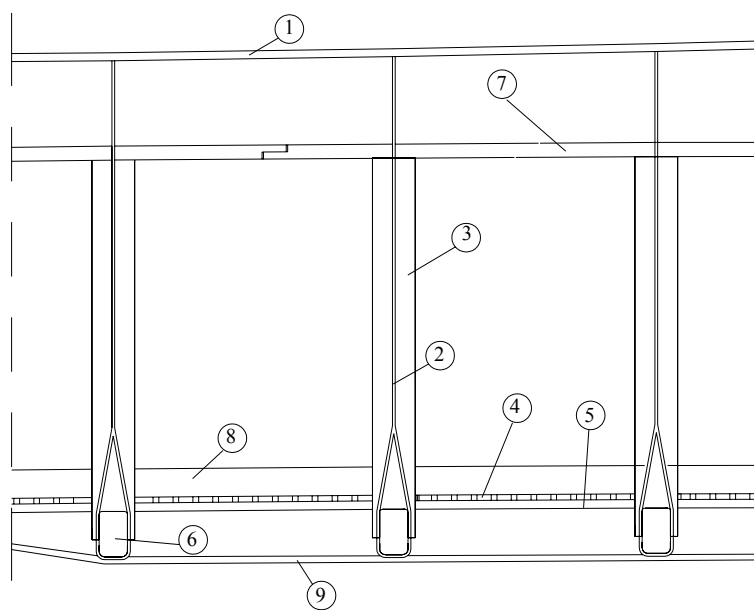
Alçado lateral – Corte na zona central da ponte.
